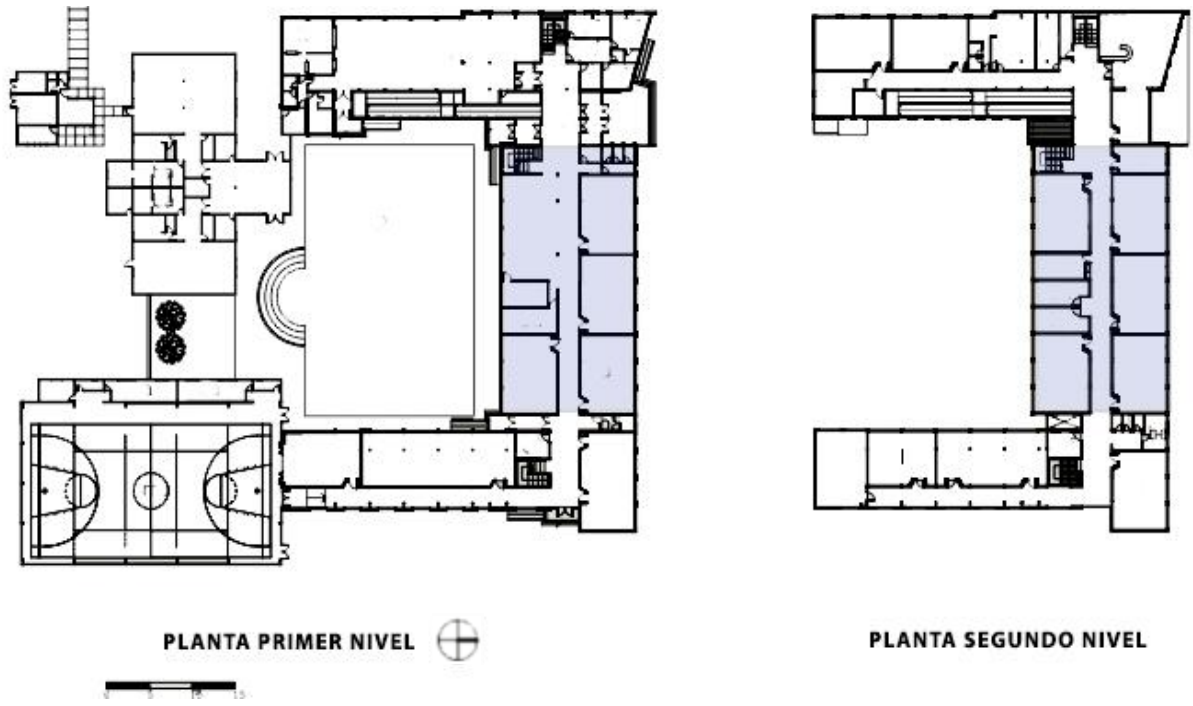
Planos de planta de Liceo Austral Lord Cochrane
